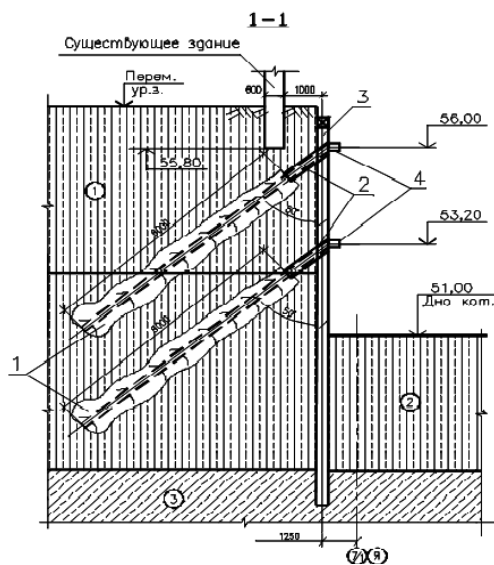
Общий вид подпорной стенки с анкерным креплением в месте примыкания здания
